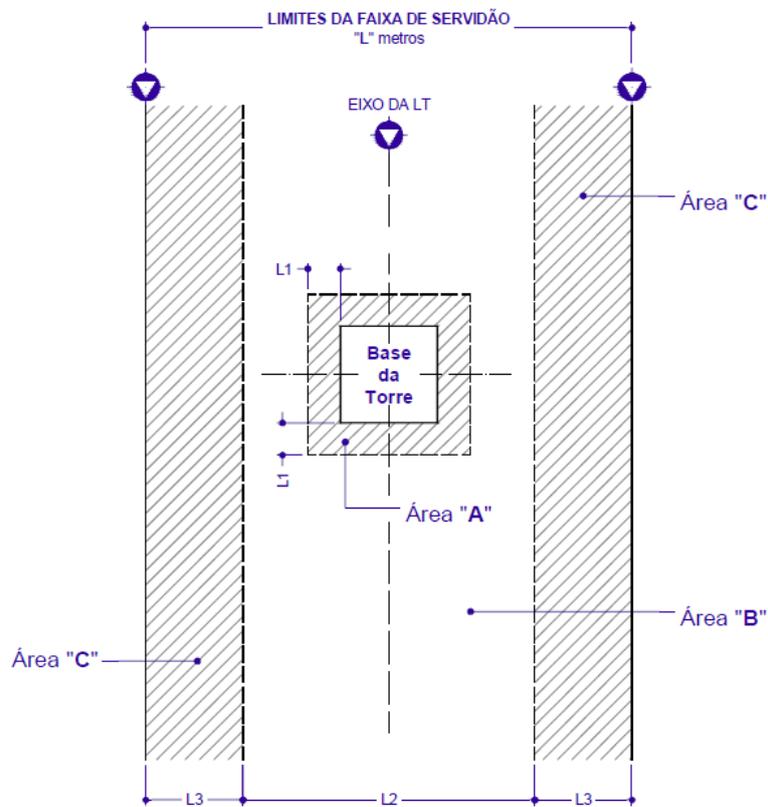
DIVISÃO DA FAIXA EM AREAS "A", "B", "C"
